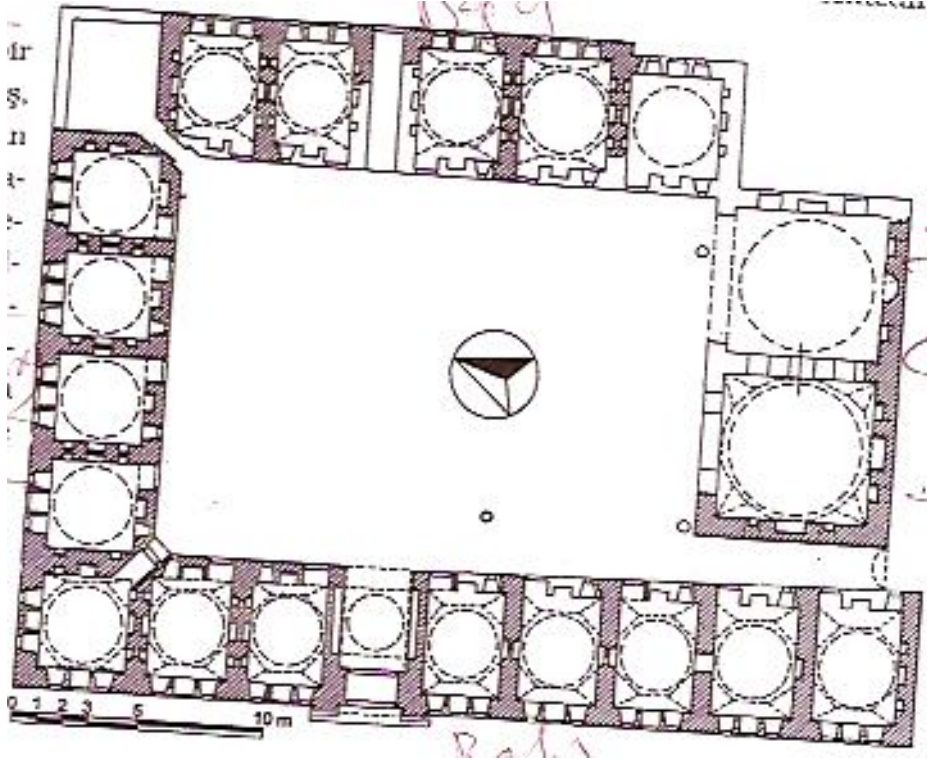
(Y.Özbek) Beylerbeyi Camii planı
